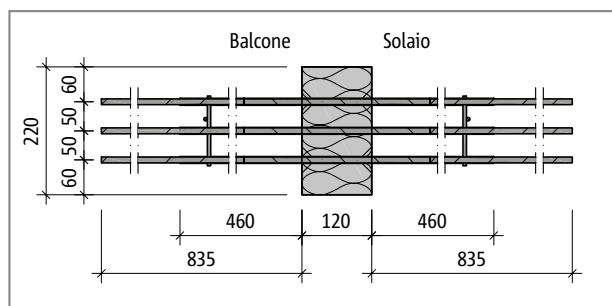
Schöck Isokorb® tipo SXT1-VB2: pianta del prodotto
